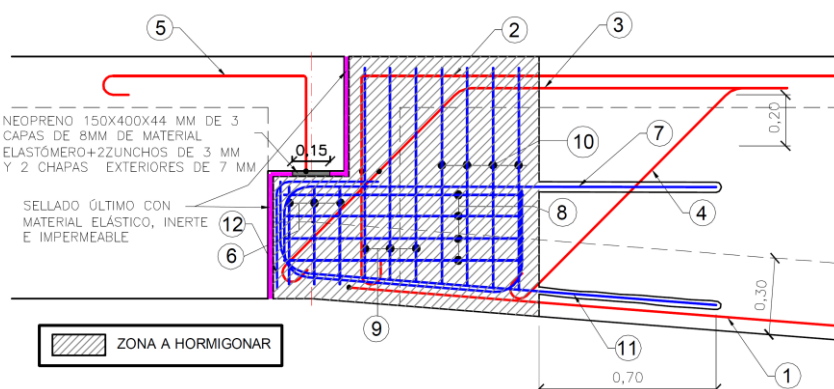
Croquis de la hidrodemolición, refuerzo de armado y posterior hormigonado.
